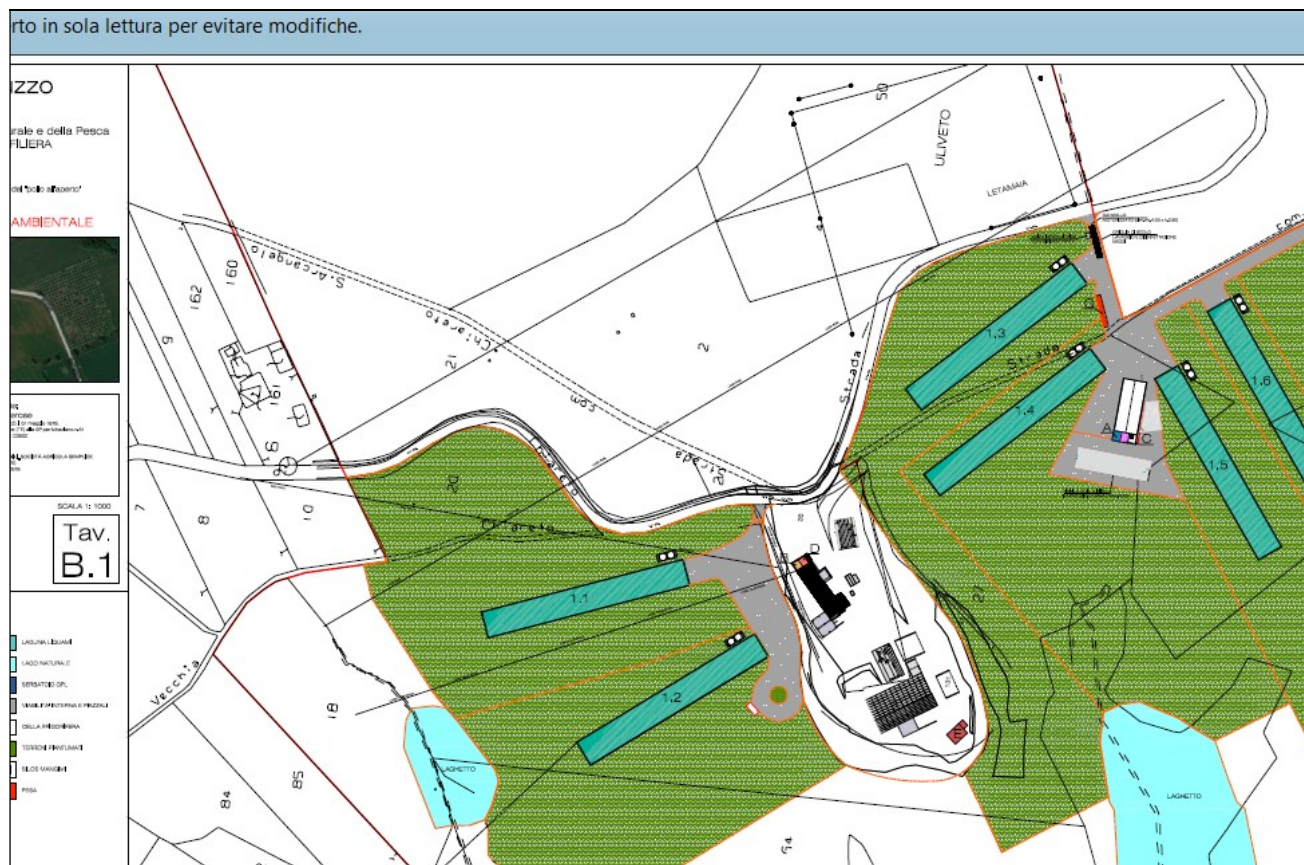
Planimetria dell'allevamento Masseria dei Nobili – Bellante (TE)
